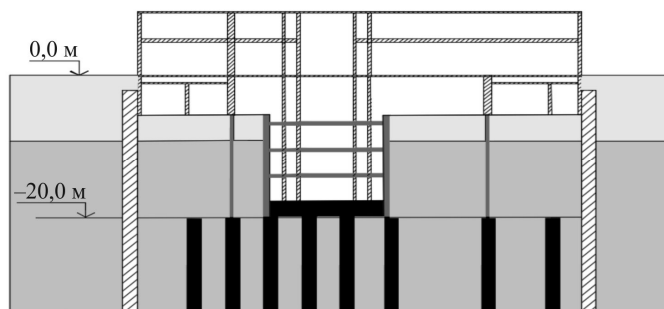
Порядок производства работ по методу «Тор-Down» на 3-м этапе: выемка грунта на этаже -4; бетонирование перекрытия на этаже -5; завершение этажа -3; возведение этажей 1-4
